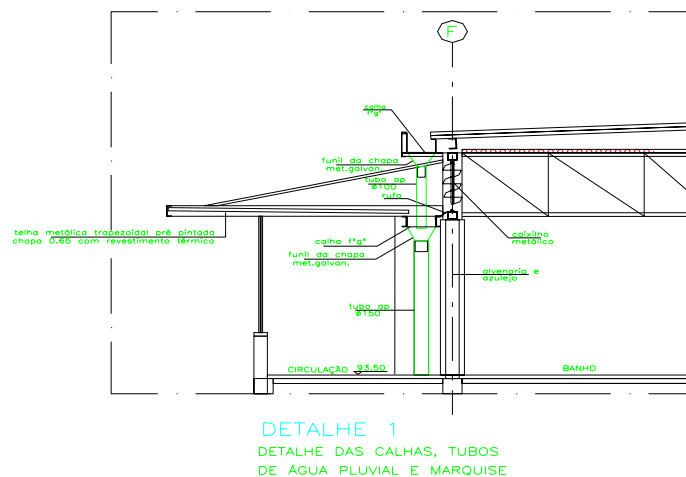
Detalhe das calhas metálicas de seção retangular, condutores verticais em PVC de água pluvial utilizado na construção da CMEI Elis Regina – (Vila Dinamarca), Guarulhos - SP
